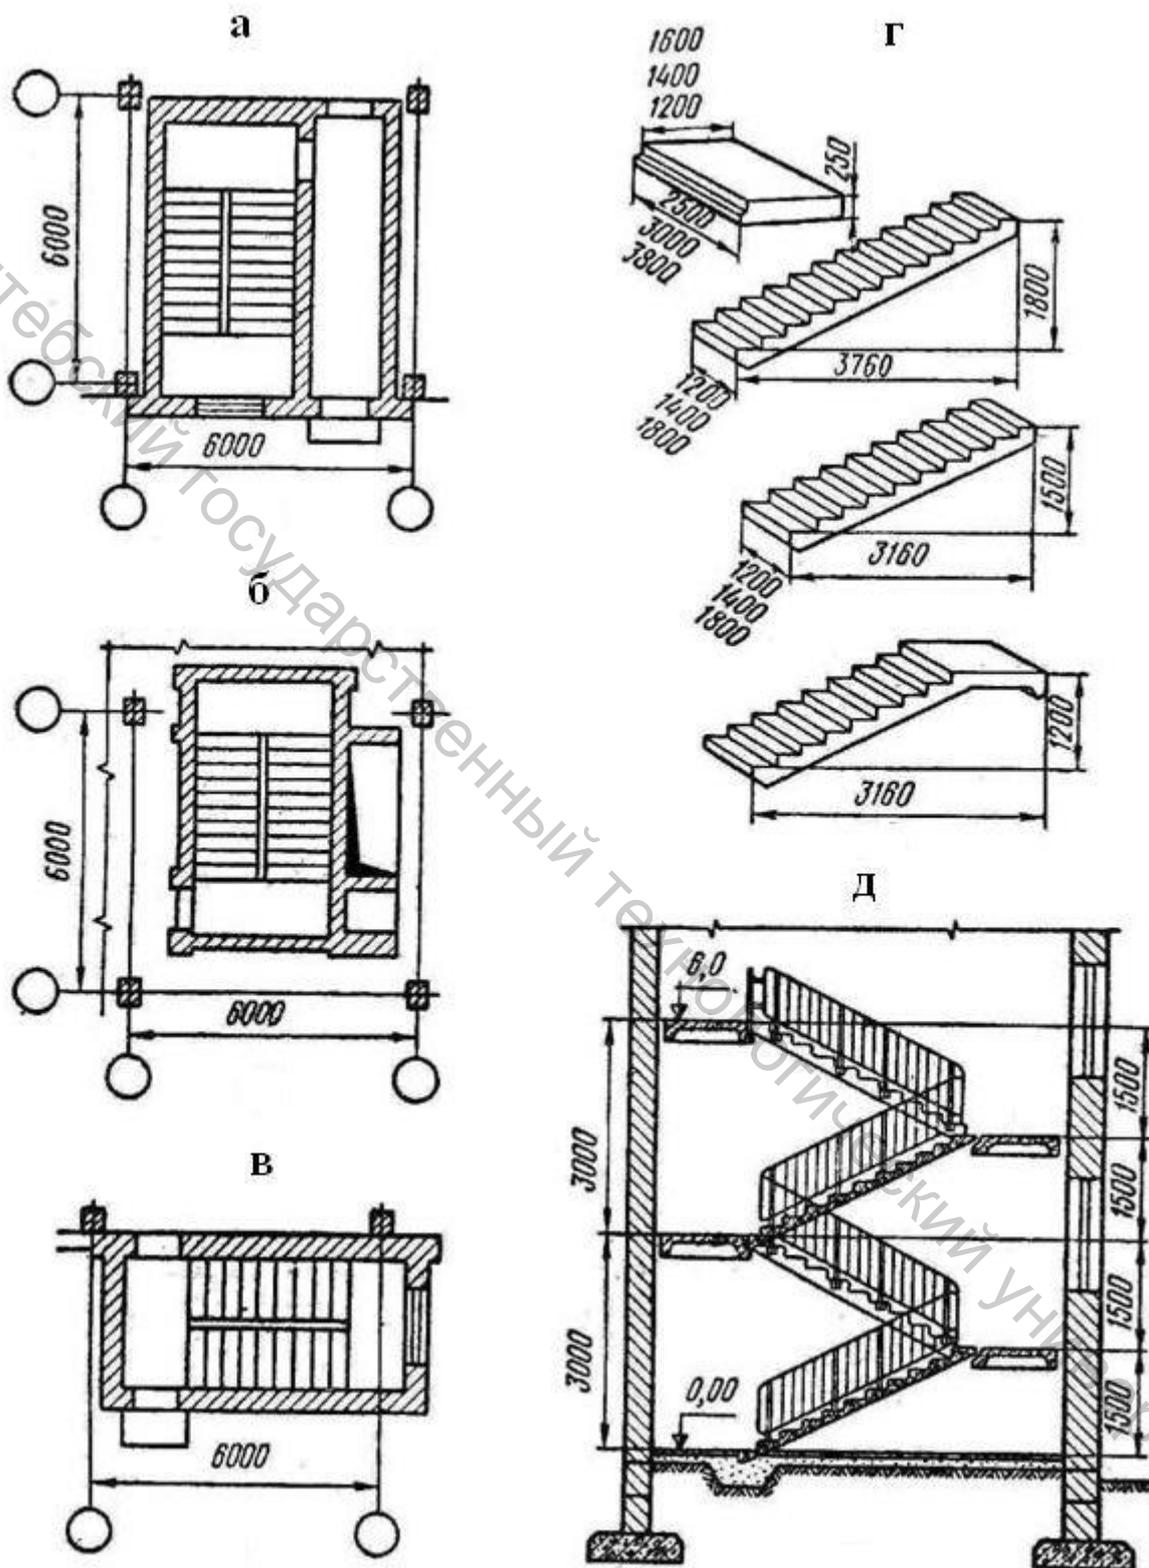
Лестницы многоэтажных зданий (а – лестничная клетка с вестибюлем, б – лестничная клетка внутри здания с вентиляционной шахтой, в – лестничная клетка в пристройке, г – типовые элементы лестницы (площадки и марши), д – разрез лестницы с высотой этажа 6 м)
